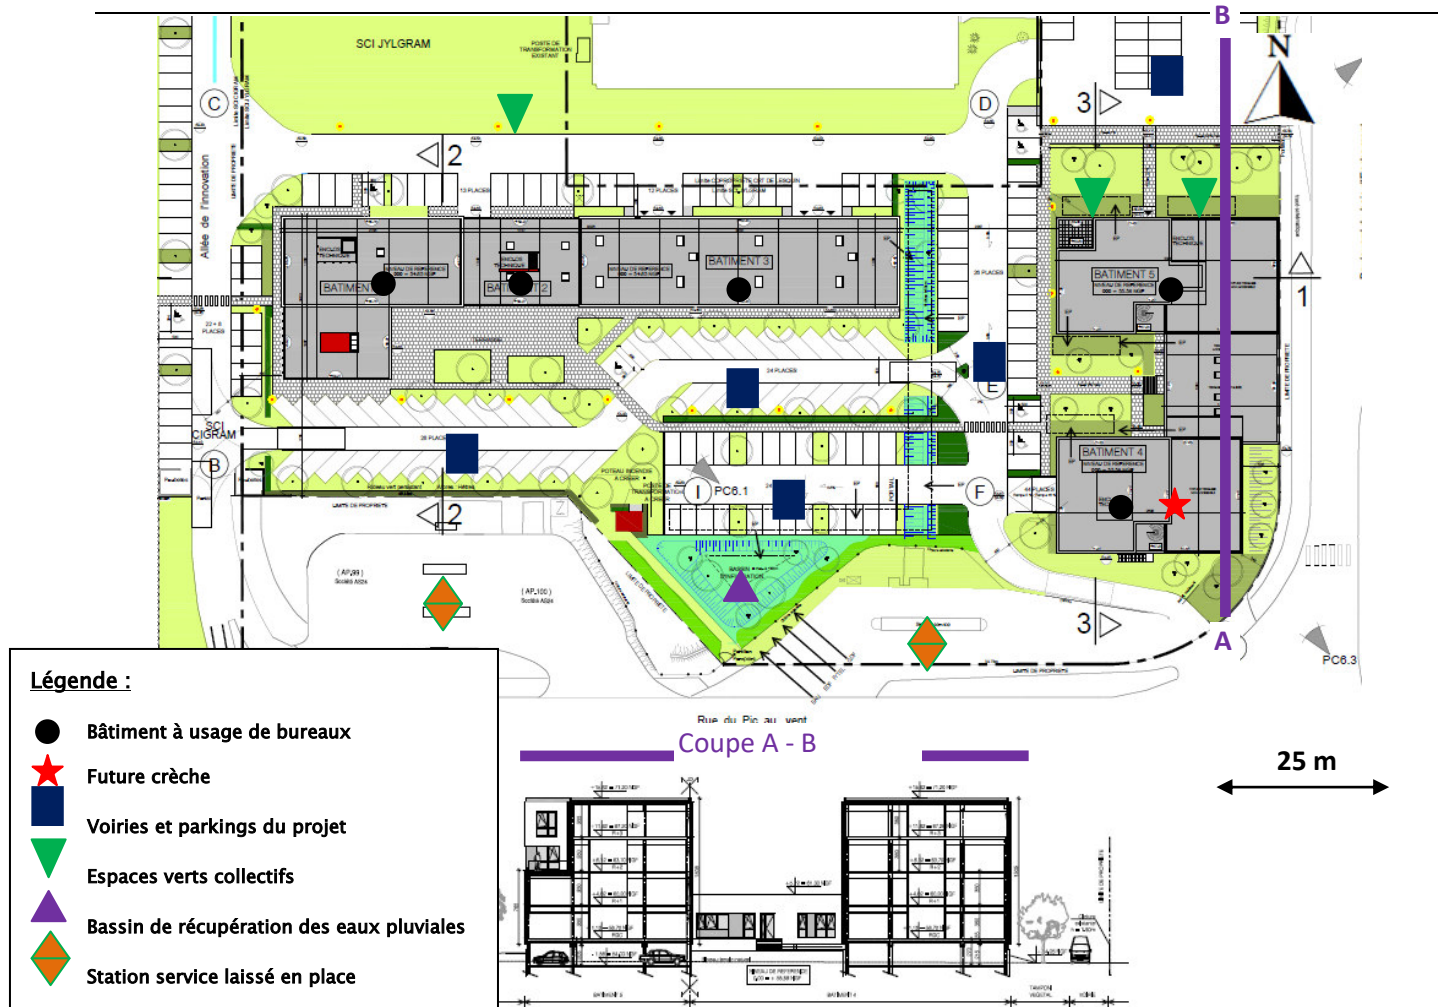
Plan masse du projet d’aménagement et coupe horizontale des bâtiments 4 et 5
